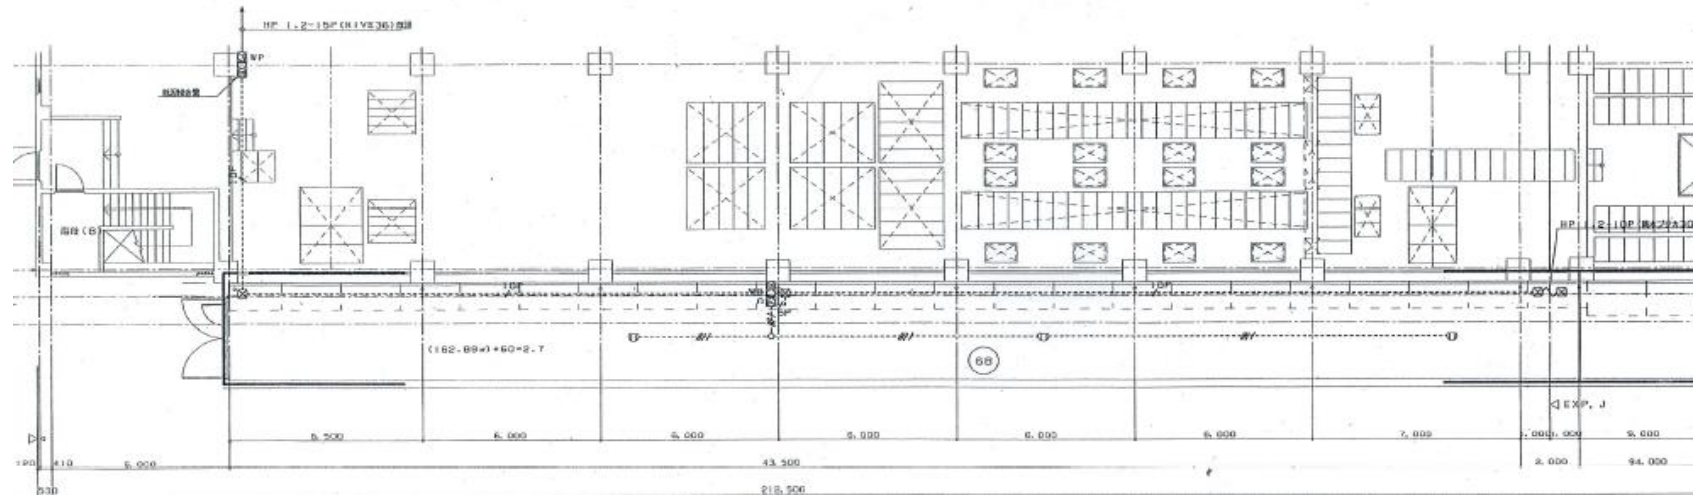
系水处理棟（最終沈殿池） 地下1階平面図（既設）
